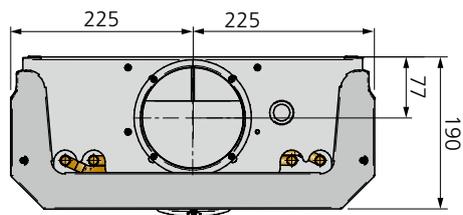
Dimensions WISE Adriatic, vue arrière du raccordement aéraulique
